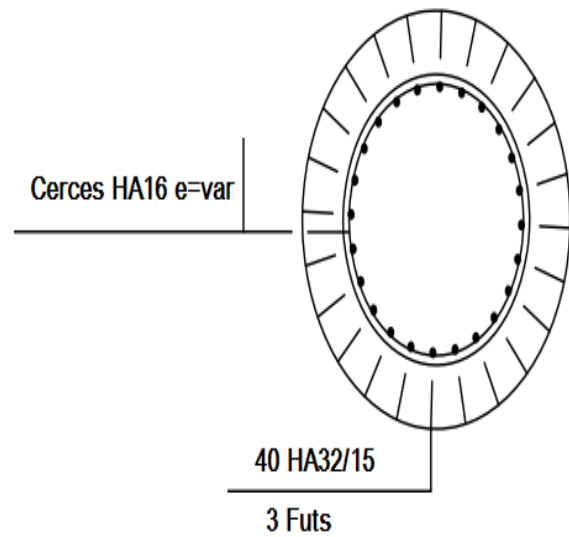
Coupe 1 sur le plan de ferrailage du FUT
